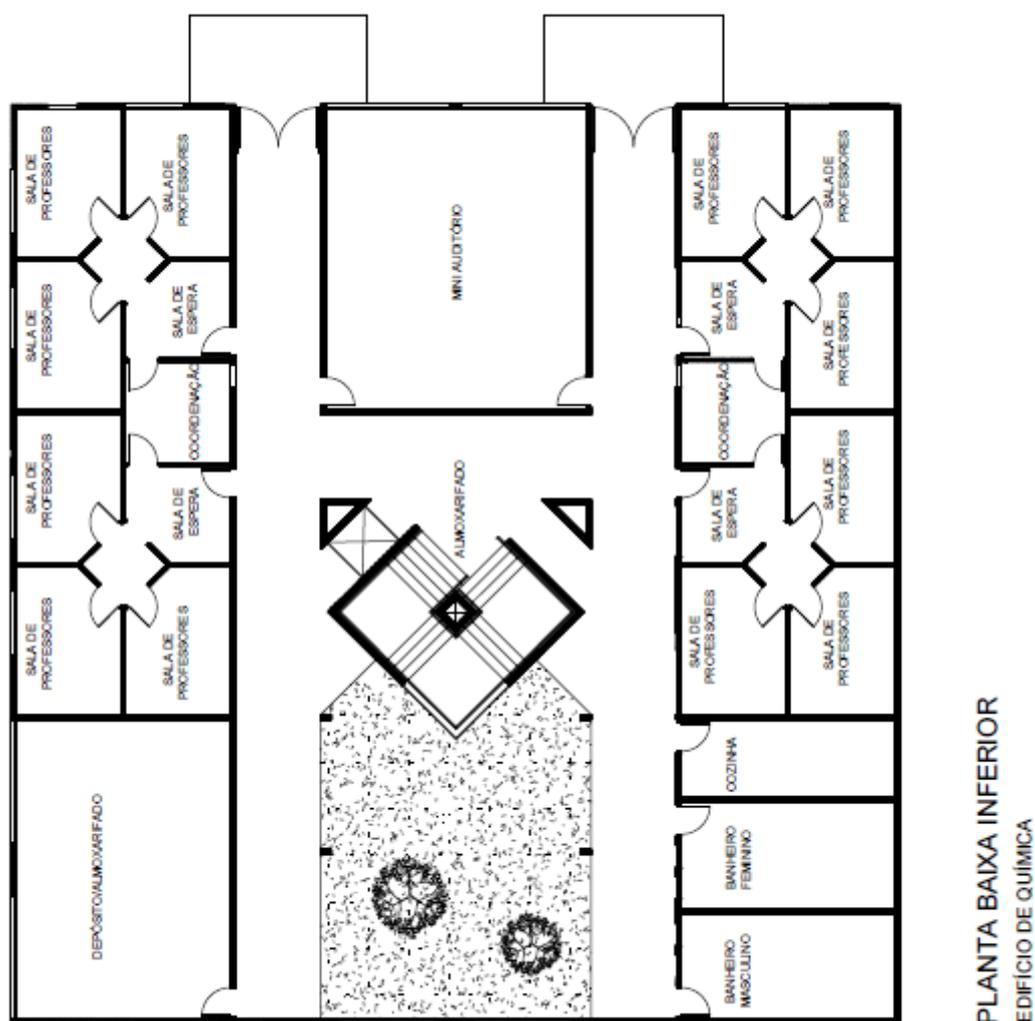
Planta do Pavimento Inferior do Bloco IV de Química
